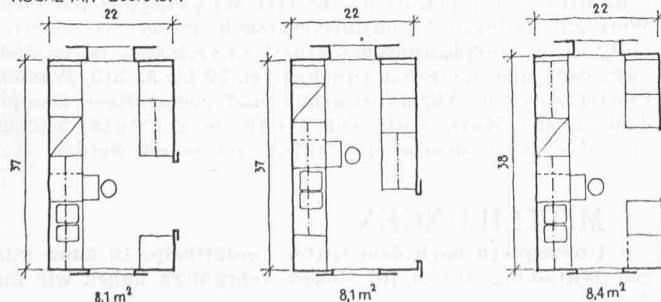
Anwendung des Standardvorschlages auf einige Küchengrundrisse
